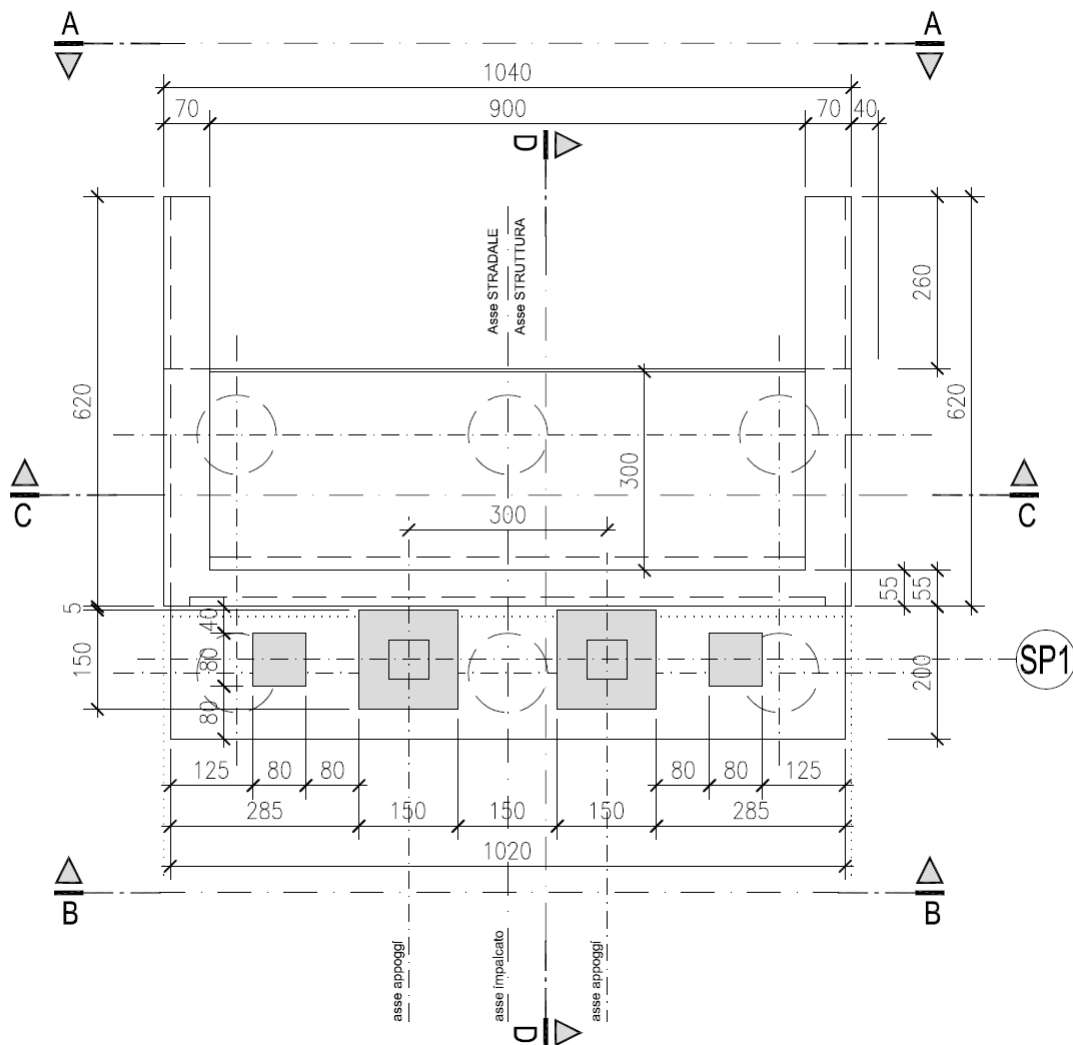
PIANTE SUPERIORE SPALLA
